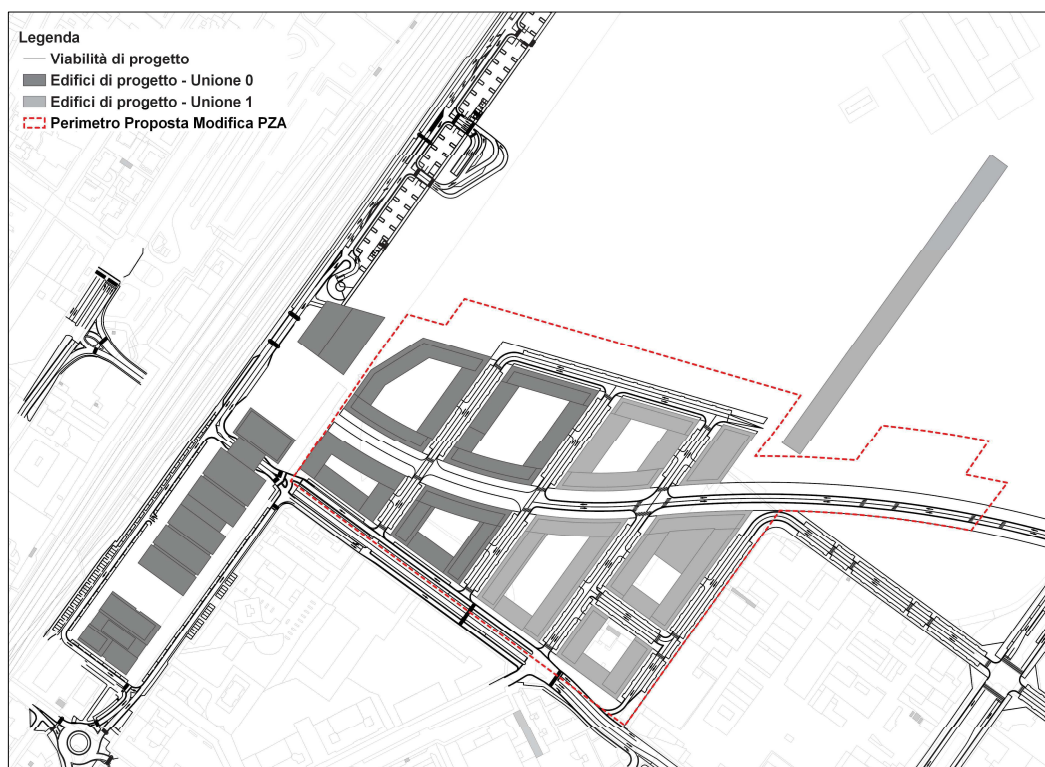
Estensione area oggetto di proposta di zonizzazione acustica (fonte: elaborati FOA)
